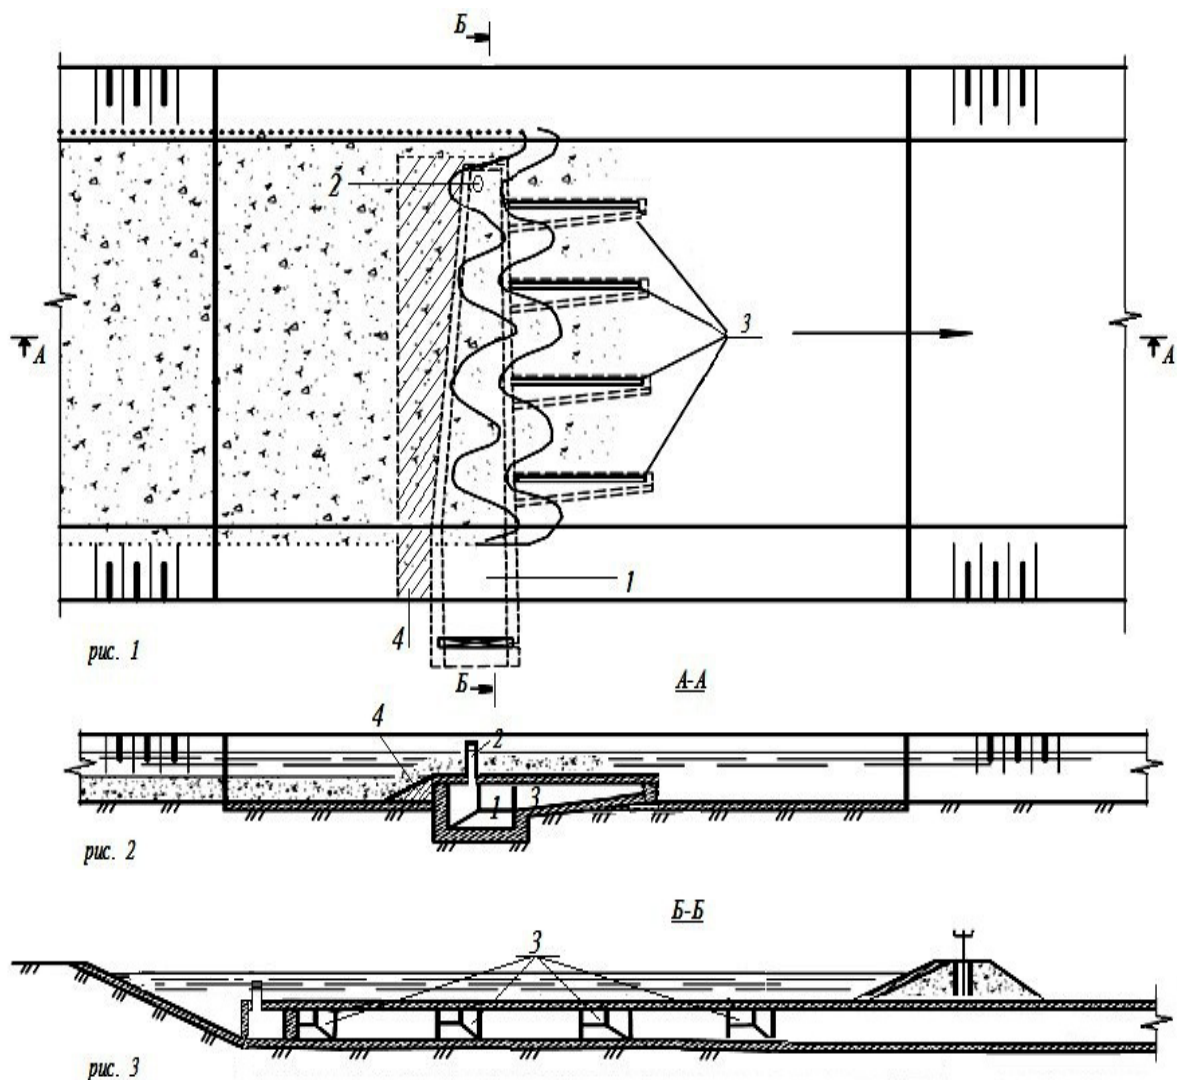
Песколовка с продольными щелевыми отверстиями: 1 – пульповод; 2 – вертикальная труба; 3 – галереи; 4 – железобетонная плита в виде откоса
